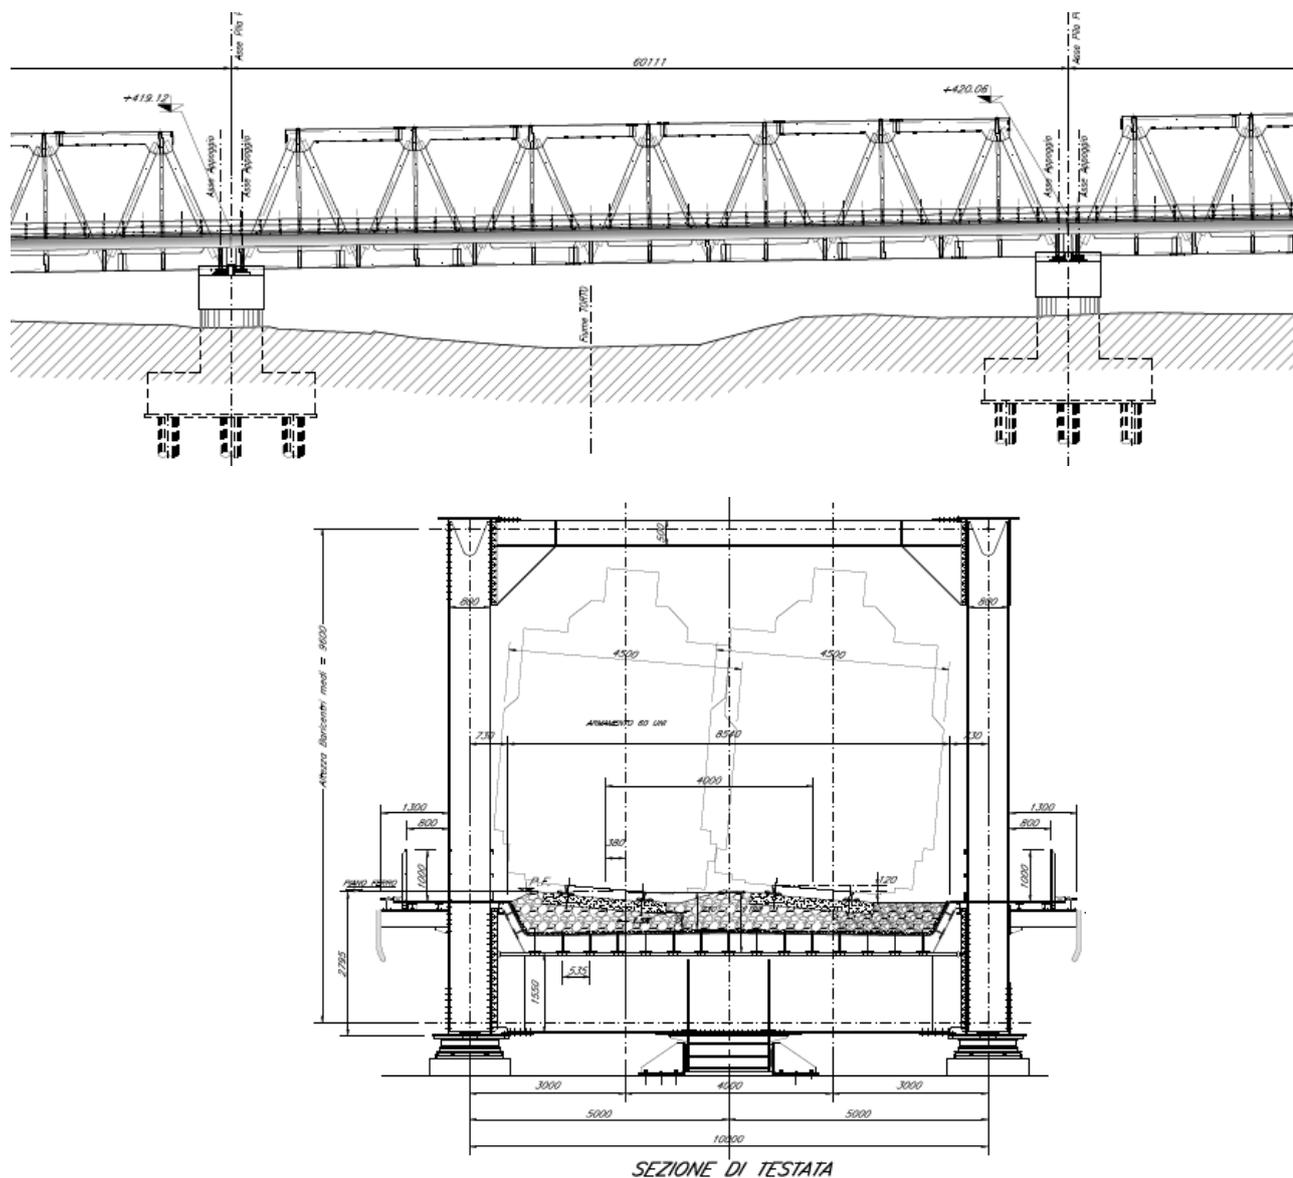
Sezione longitudinale e trasversale impalcato VI01 da 60 m in travata metallica reticolare
